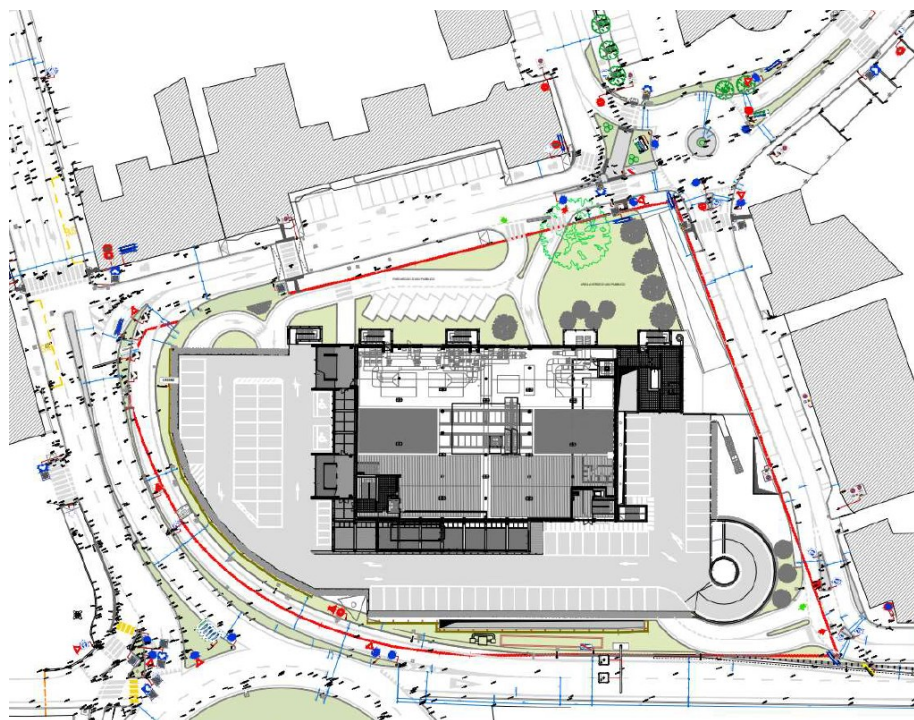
Planimetria di progetto viabilità esterna Palazzo del Mobile
